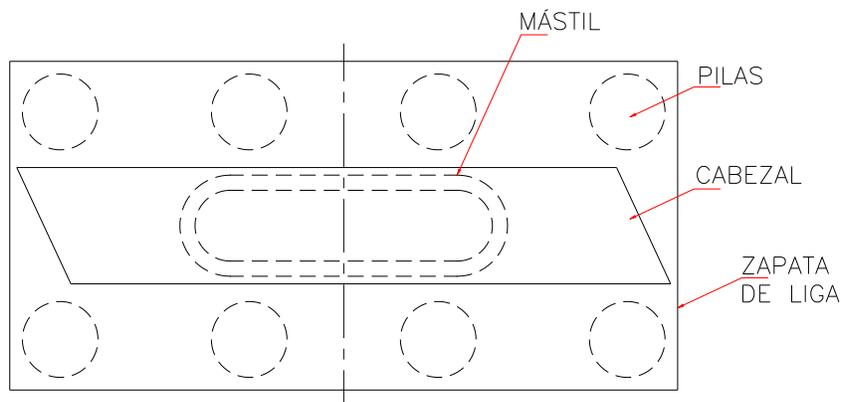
Vista en planta de la cimentación (zapata de liga entre base de la columna y pilas de cimentación)
